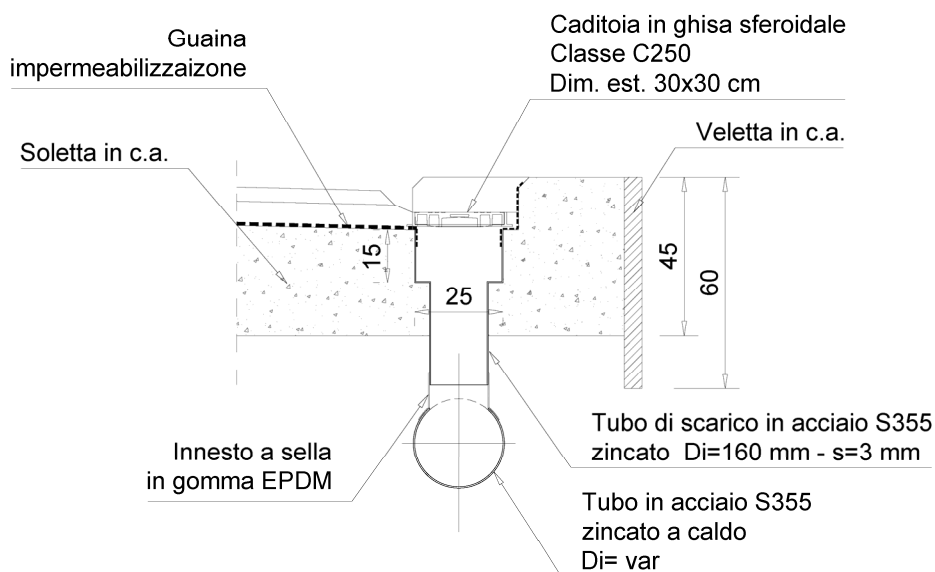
sistema di drenaggio – sezione in viadotto
